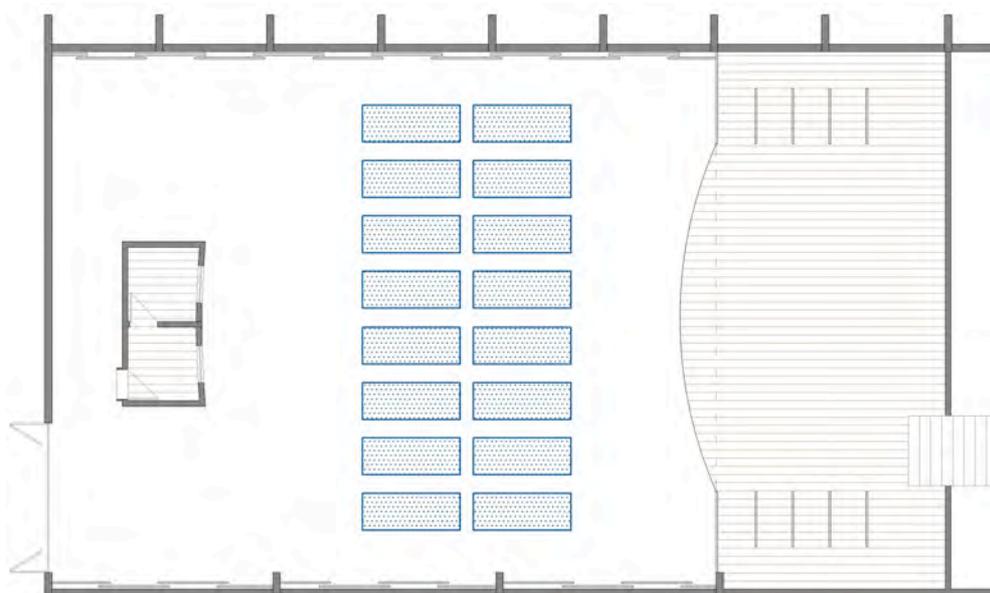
ANFI - 9. Planta com localização de painéis refletores.
